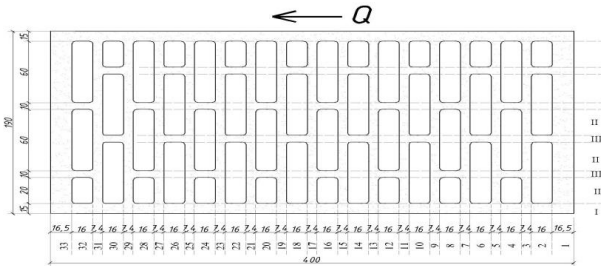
Расчетная схема мелкого блока из пенобетонного камня с 8 сквозными щелевидными пустотами.
